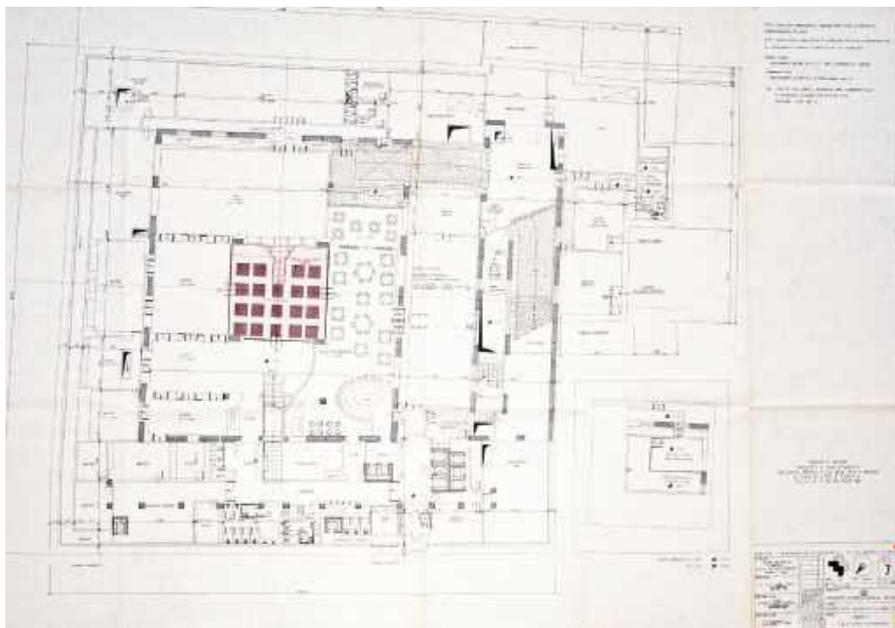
Pianta piano interrato, progetto di restauro e riuso; tavola su carta
